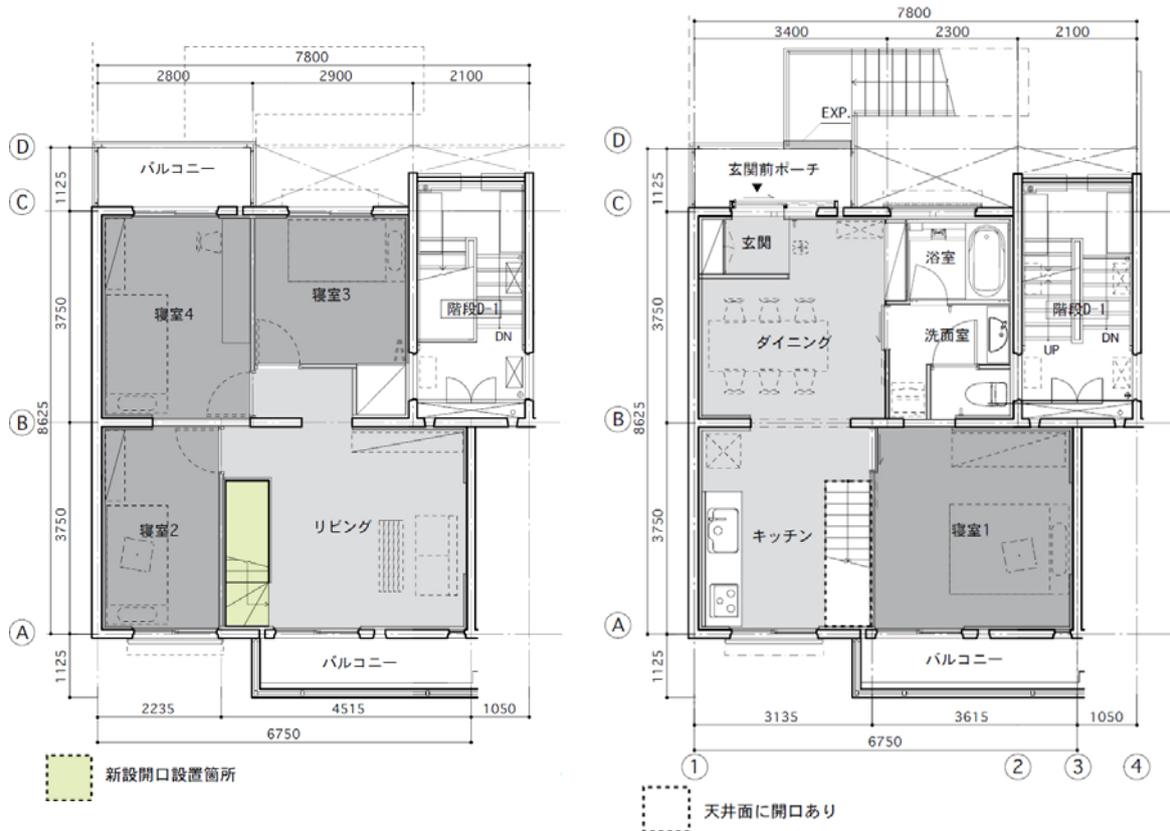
メゾネット住戸（スラブ開口最小タイプ）の平面図（左：下階，右：上階）
